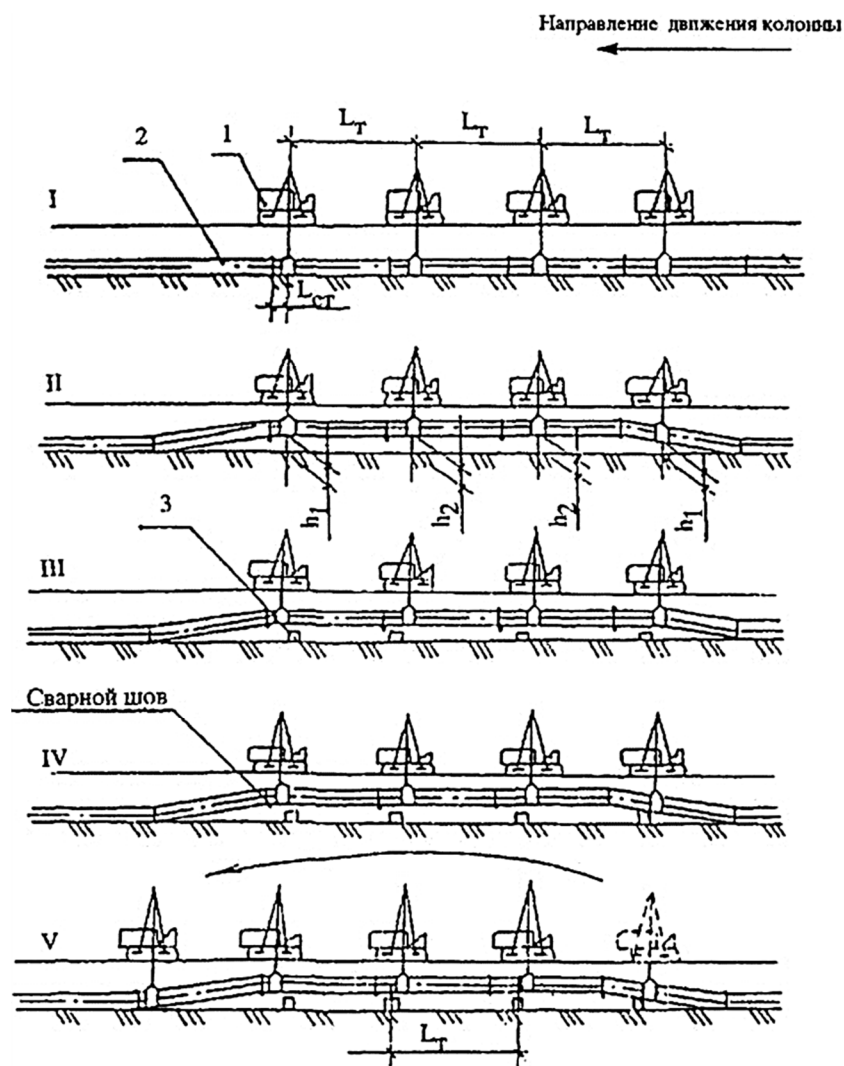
Схема подъёма и укладки нефтепровода на лежки с переходом одного трубоукладчика: 1 – трубоукладчик; 2 – нефтепровод; 3 – лежка; L_T – расстояние между трубоукладчиками; L_n – расстояние между лежками; L_{cm} – расстояние от места установки полотенца до поперечного сварного шва; h_1 – высота подъёма под крайними трубоукладчиками; h_2 – высота подъёма под средними трубоукладчиками
